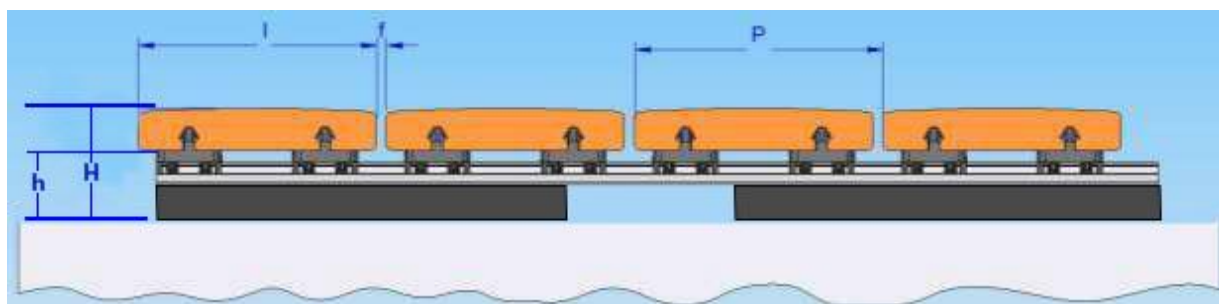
sezione longitudinale dei listoni in legno fissati su sottostruttura in alluminio KIT 60 ad altezza fissa
